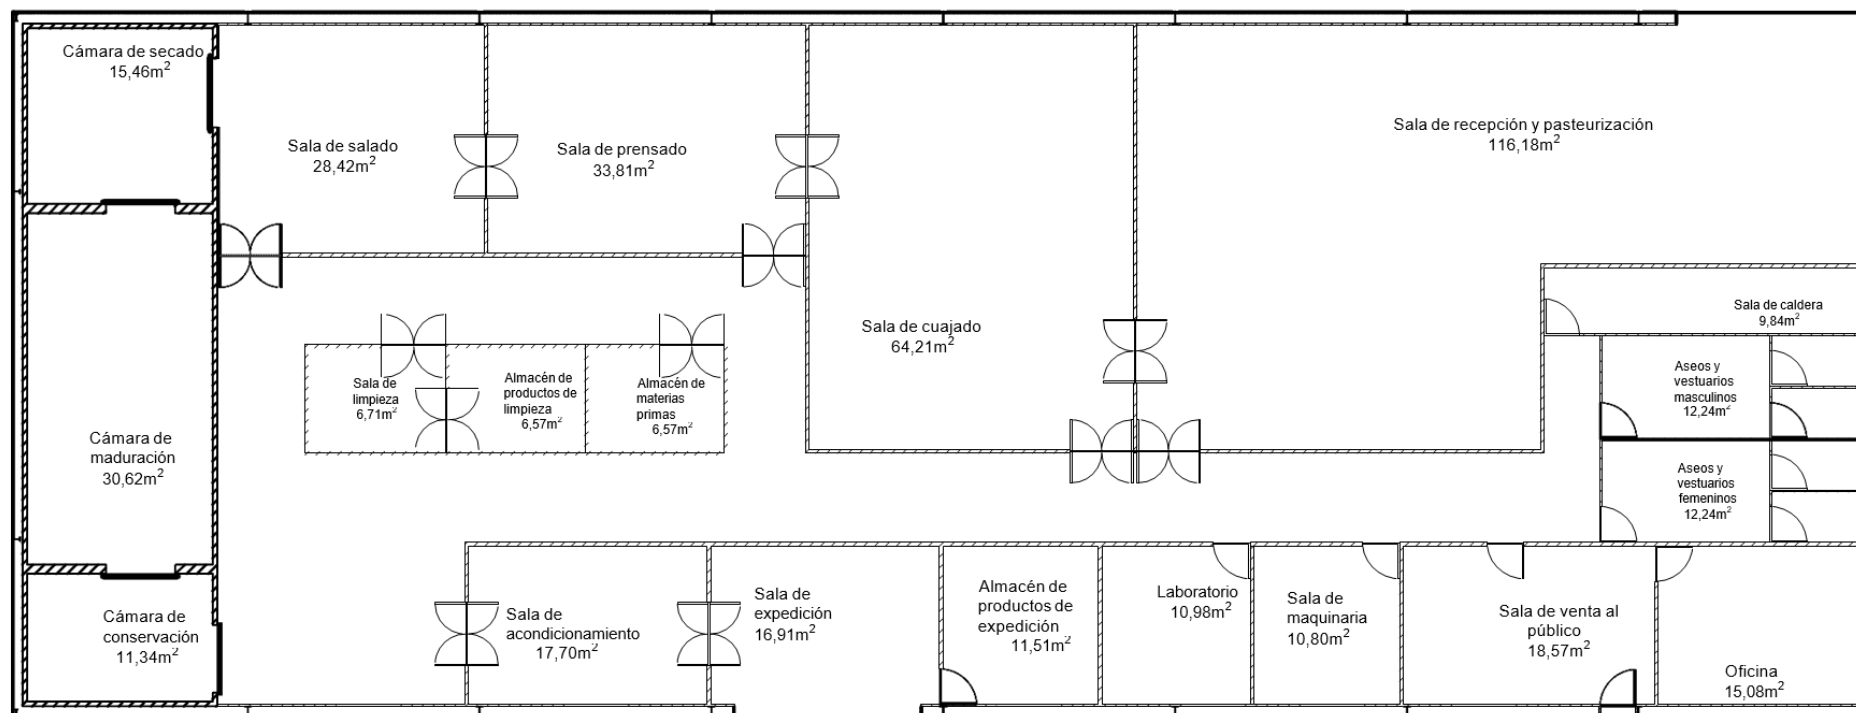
Distribución en planta y dimensiones de las distintas salas en la industria
